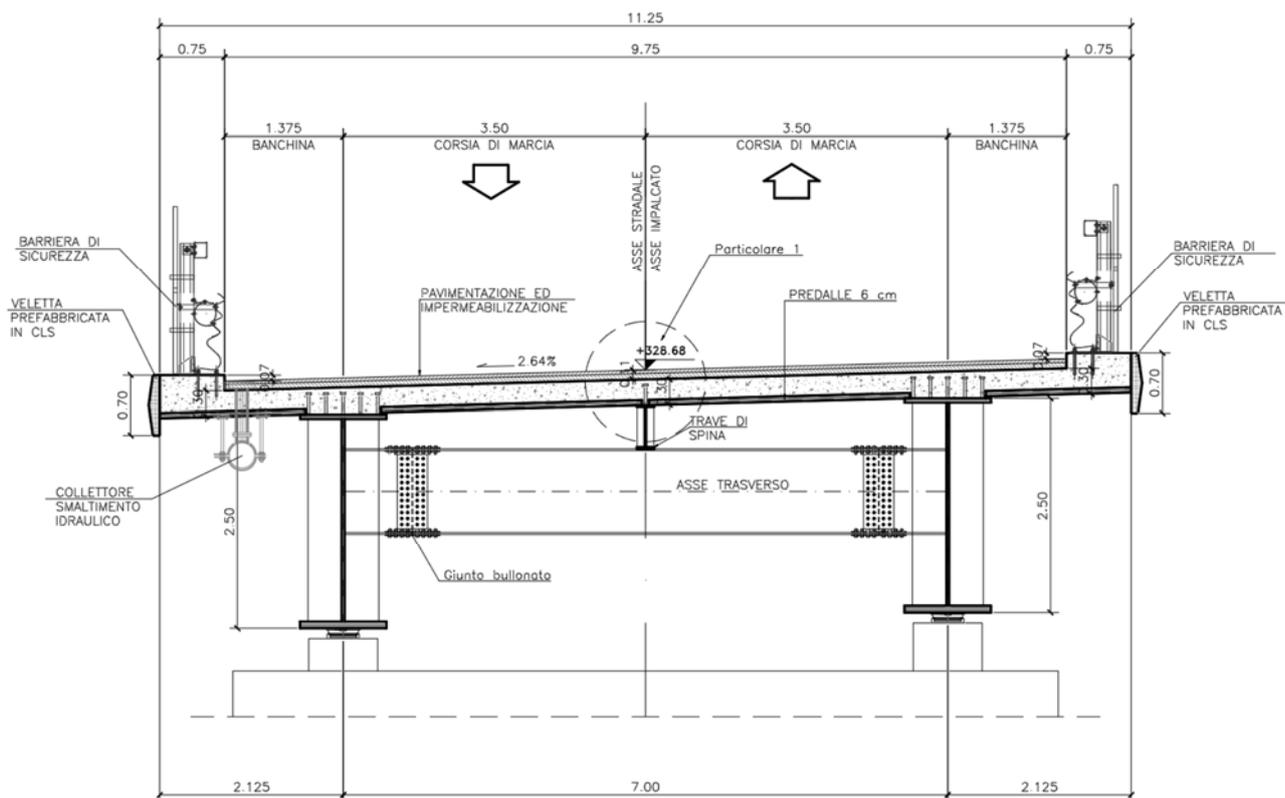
Sezione trasversale dell'impalcato del viadotto Marroggia
